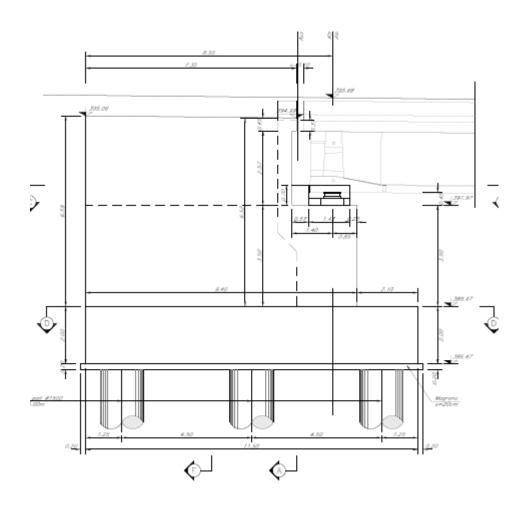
elaborati grafici spalla A (fissa)
